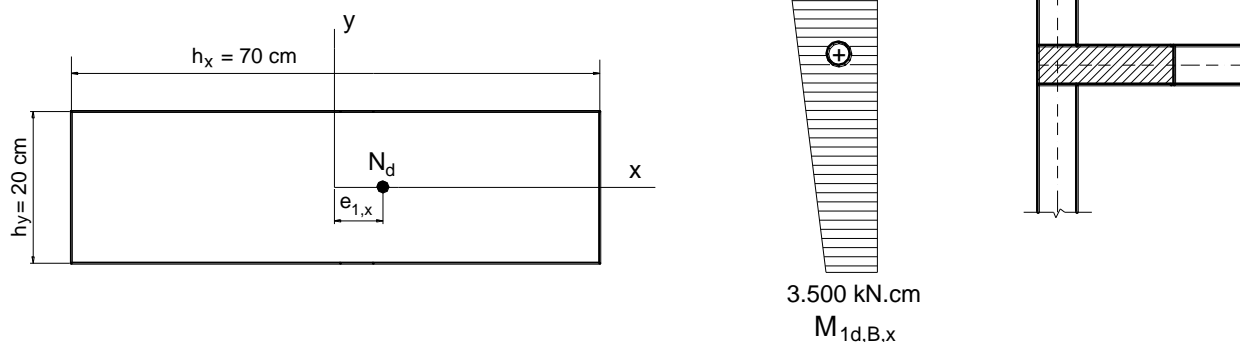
Dimensões da seção transversal, arranjo estrutural do pilar na planta de fôrma e momentos fletores de primeira ordem na direção x.
